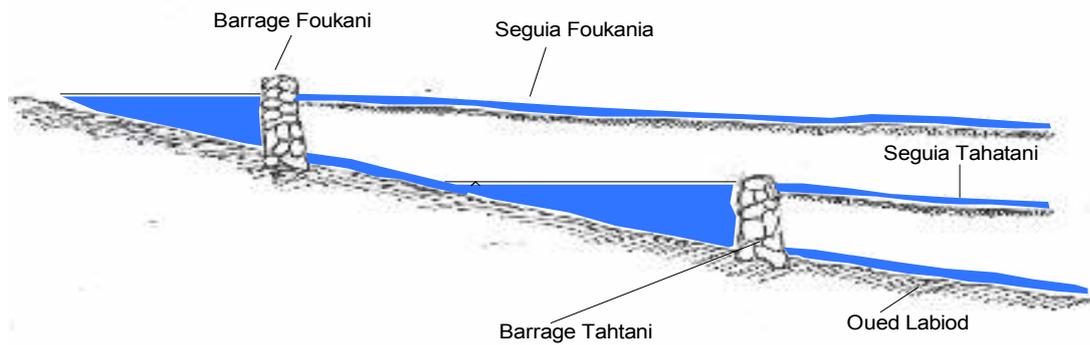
Schéma d'une coupe longitudinale des barrages (Remini, 2016)
